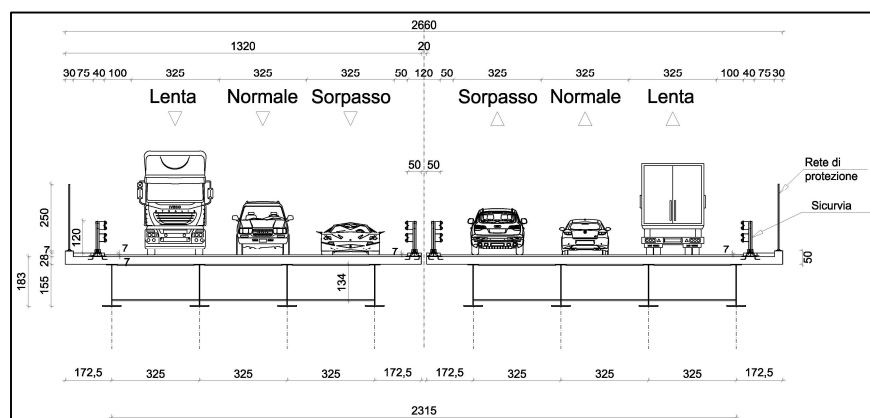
Sezione trasversale impalcato zona mezzeria
